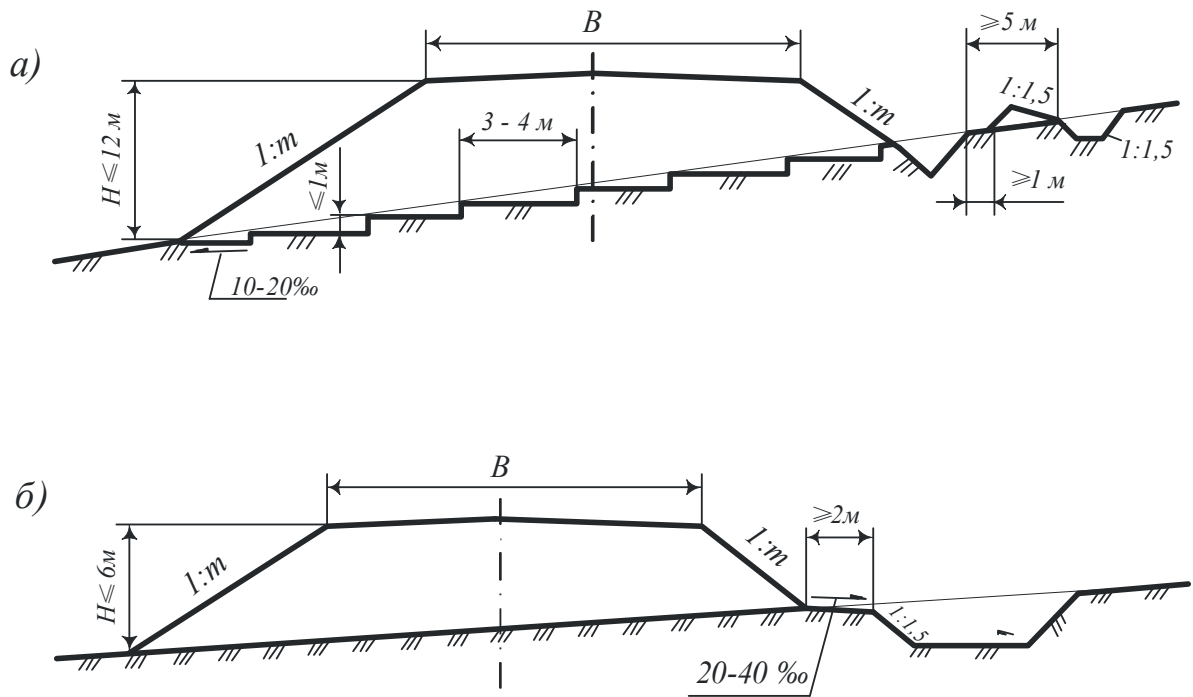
Поперечные профили типовых насыпей на косогоре:
